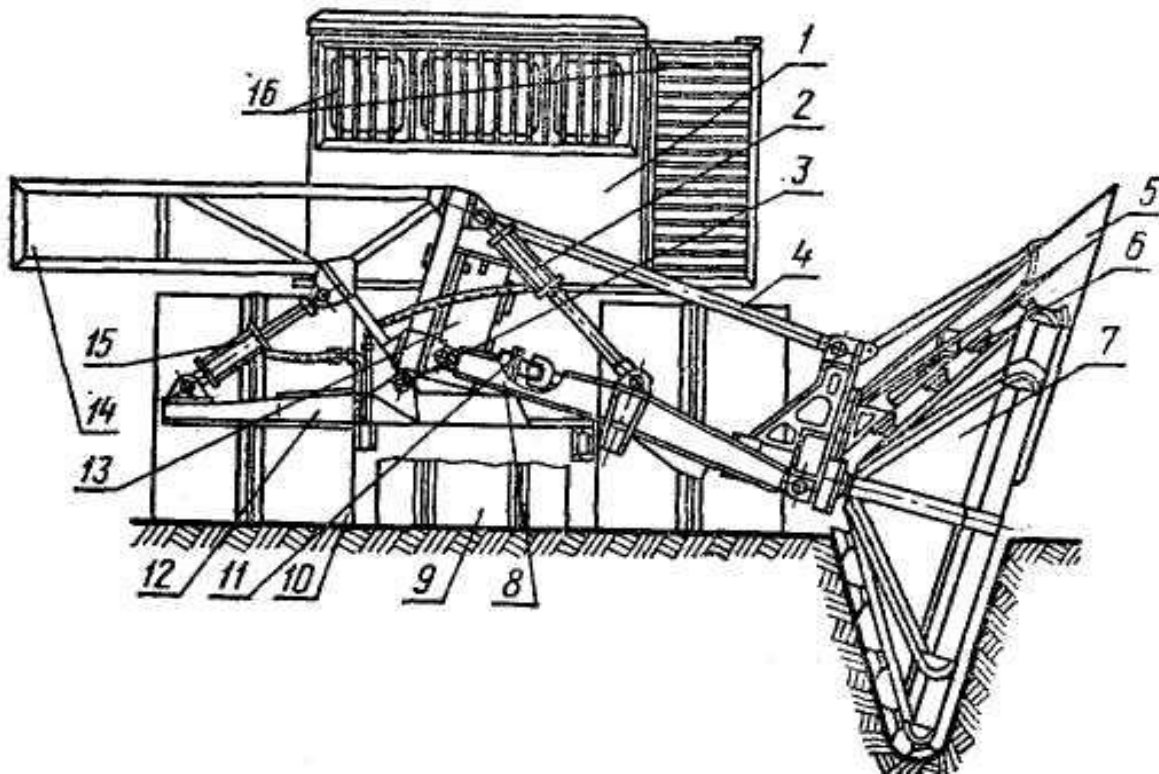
Прицепной фрезерный каналокопатель с копирующей фрезой (вид сзади):
